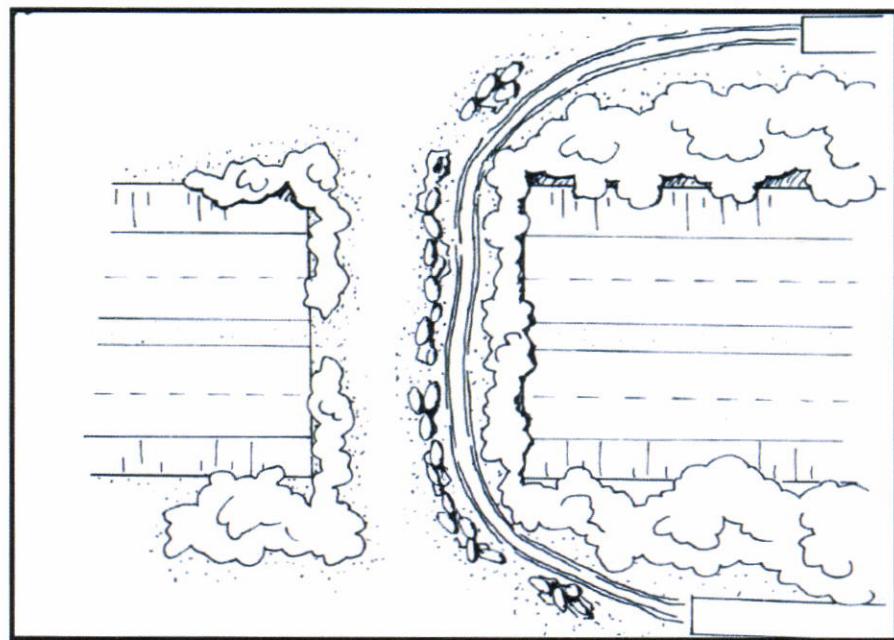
Размещение зелёных насаждений на биопереходе мостового типа с грунтовой дорогой
